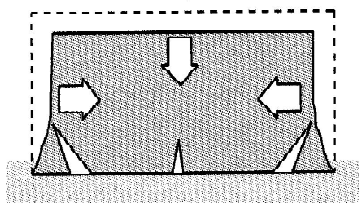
一辺拘束の場合のひび割れ発生予想図³⁾
